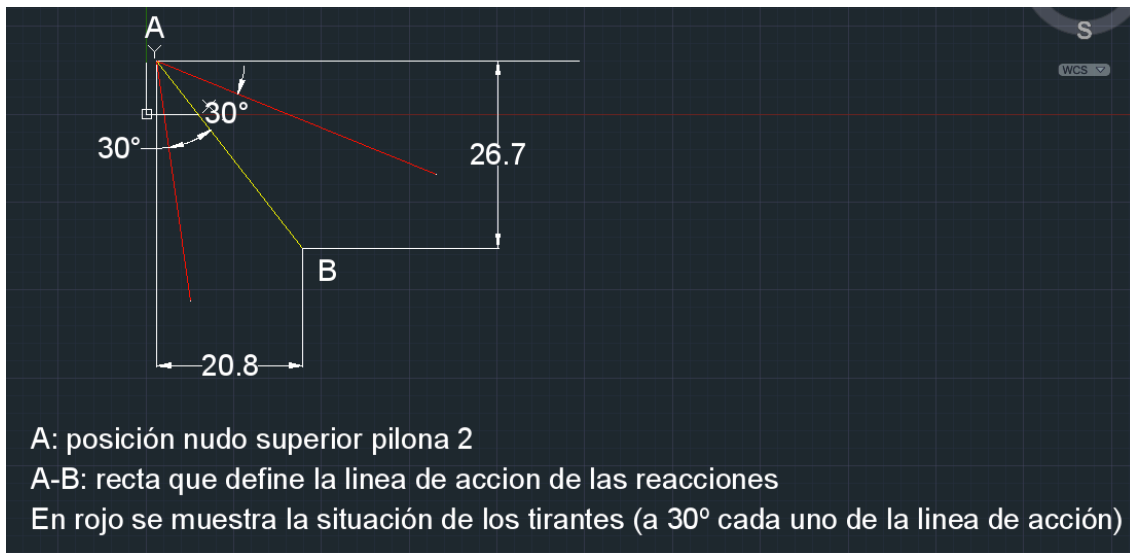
Vista superior del atirantado de la pila 2. Método
